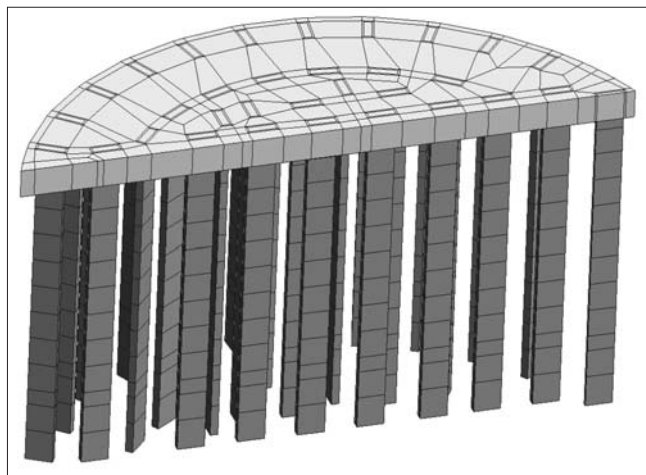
Модель фундамента для расчета методом конечных элементов КСПФ башни А
